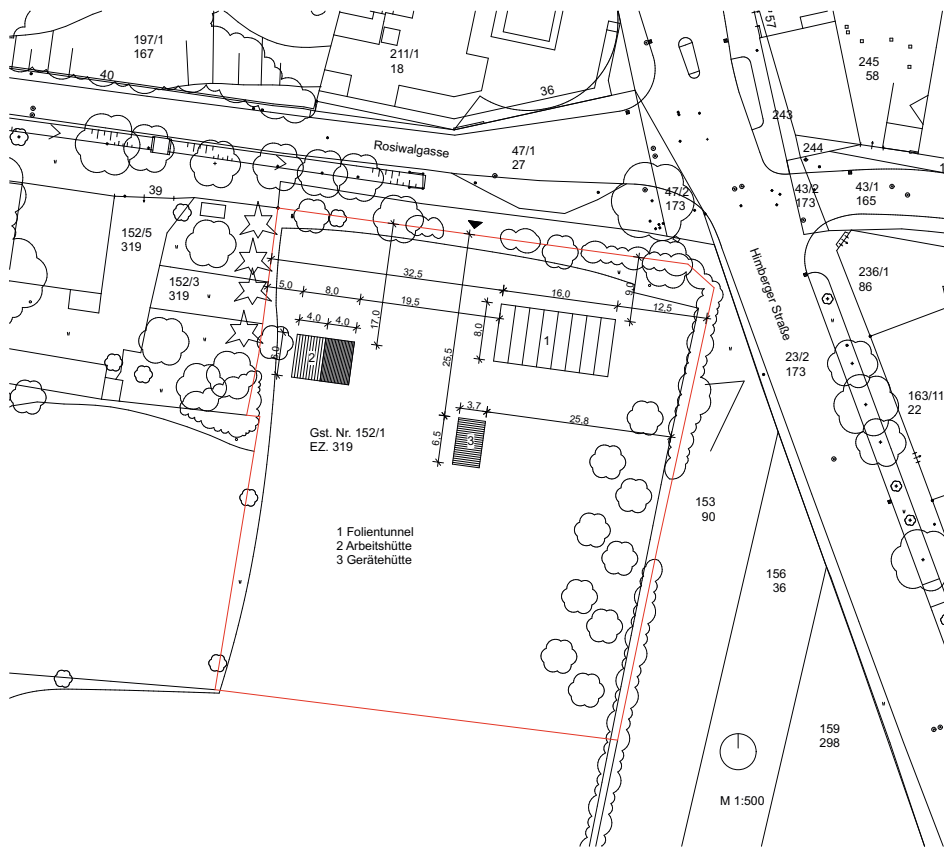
Einreichplanung Lageplan (Lengauer)
